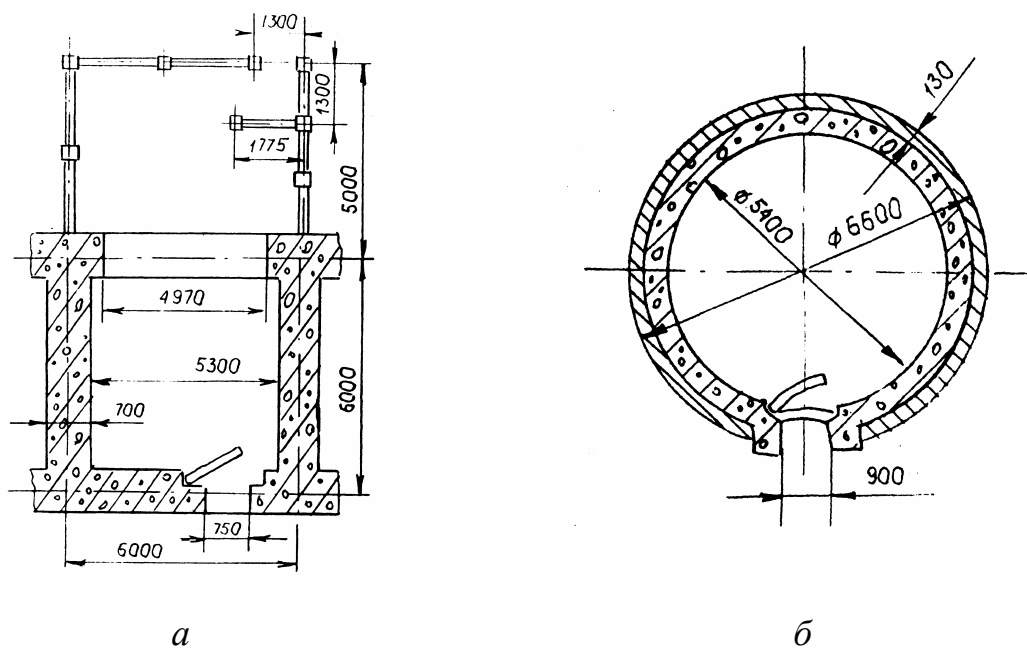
Устройство кабин прямоугольной (а) и круглой формы (б)
